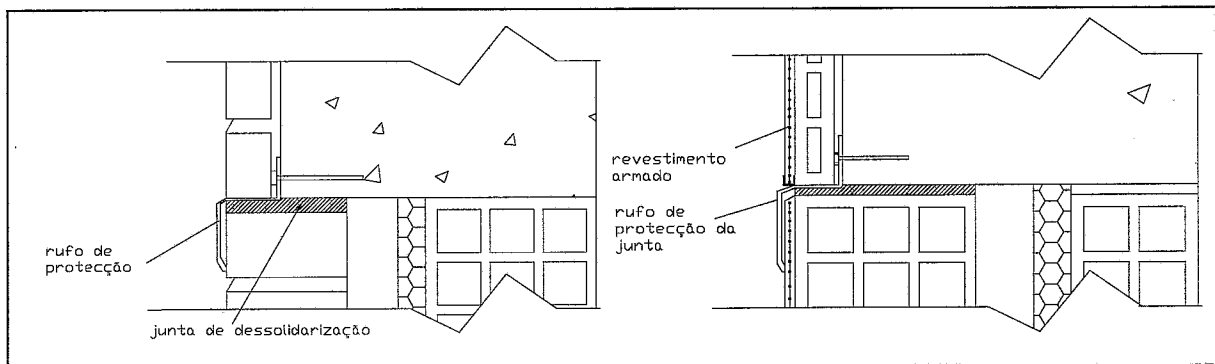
Pormenor do rufo de protecção da junta horizontal de dessolidarização
